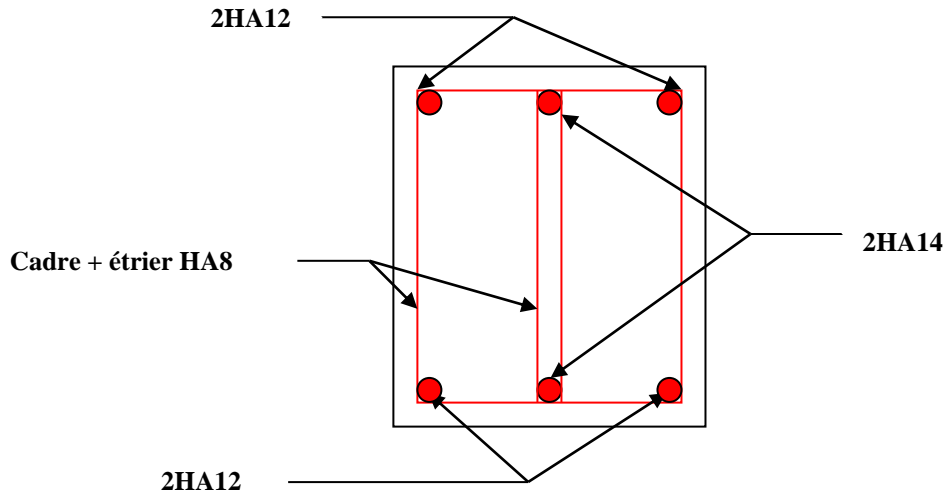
Schéma de ferrailage de la poutre brisée
